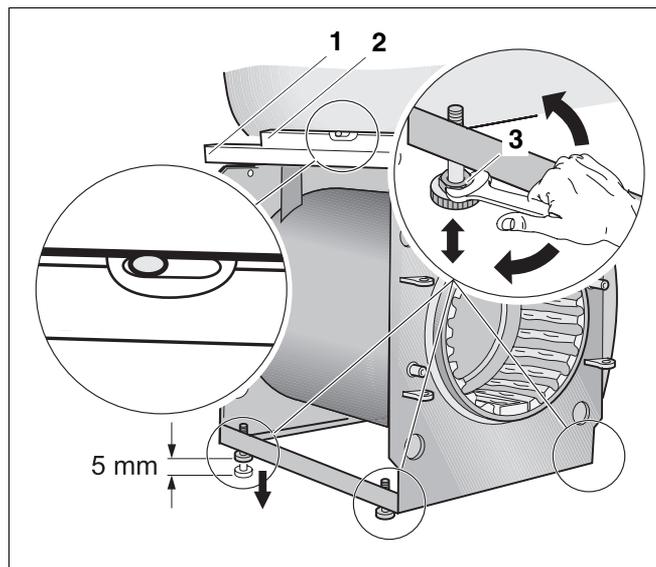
Heizkessel mit Fußschrauben ausrichten
